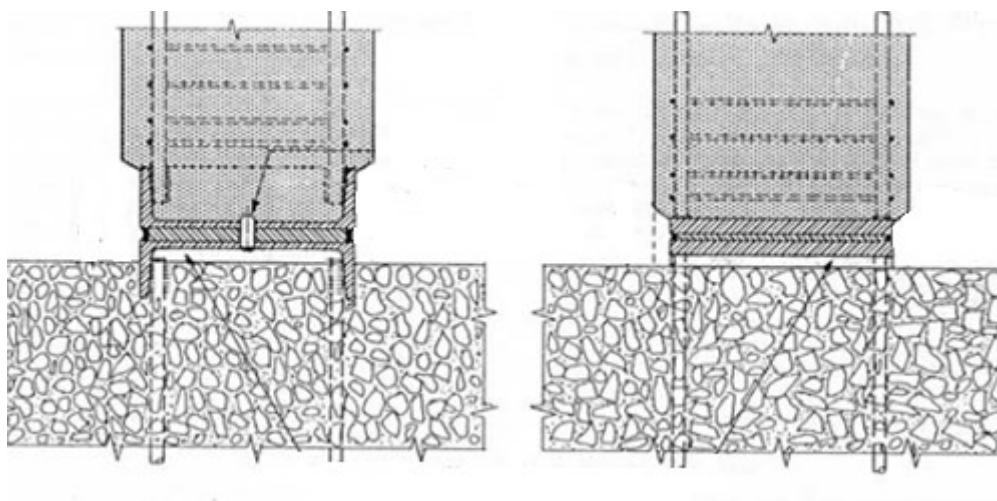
Modelo de ligação sapata-pilar através de soldaduras (STUPRÉ, 1981).
